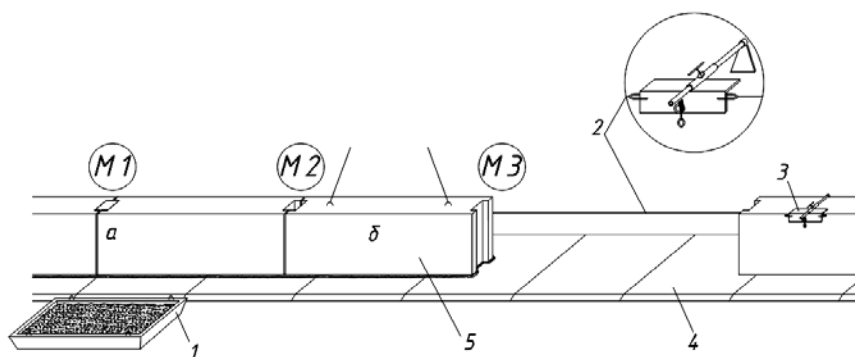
Технологическая схема монтажа фундаментных стеновых блоков:
